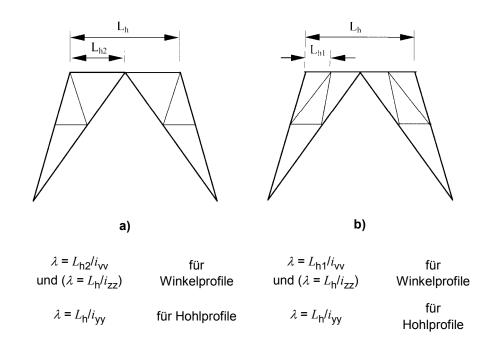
Horizontalstäbe beim K-Fachwerk ohne horizontale Ausfachungsebene
